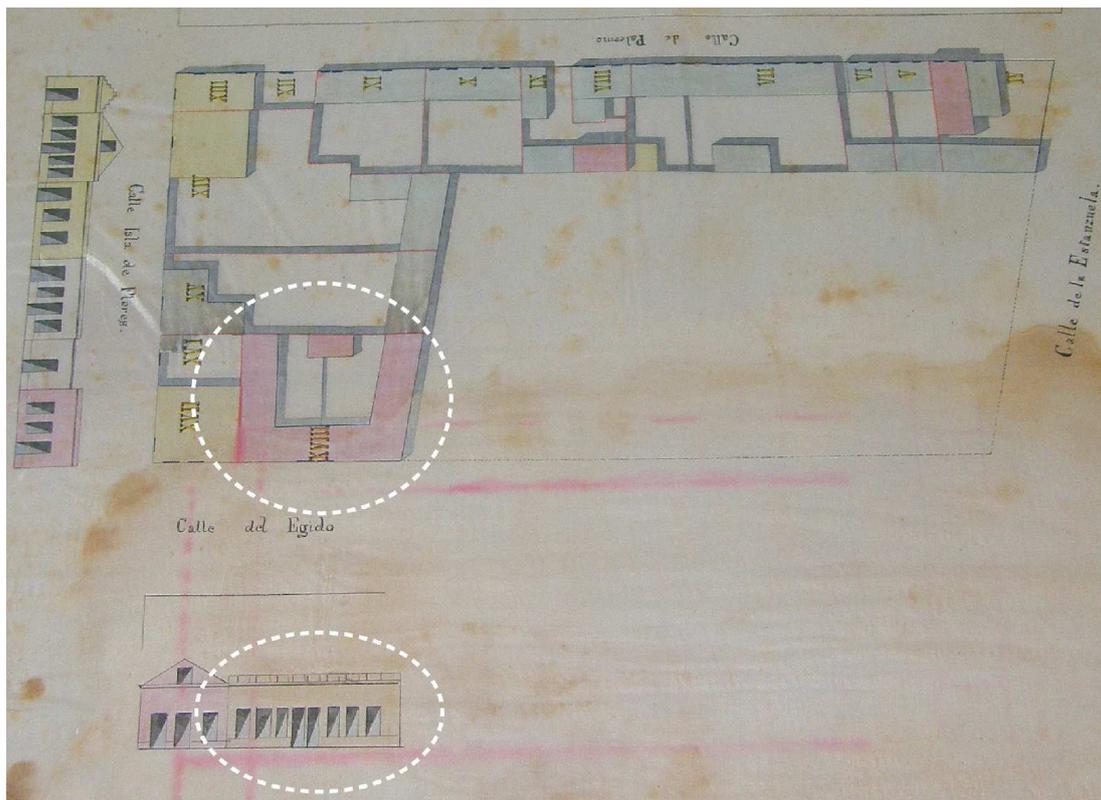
Catastro Ing. Capurro, 1870-71. Se señala planta y fachada del "Conventillo" identificado en el plano con el número XVIII. Fuente: MHN Casa Giro.
